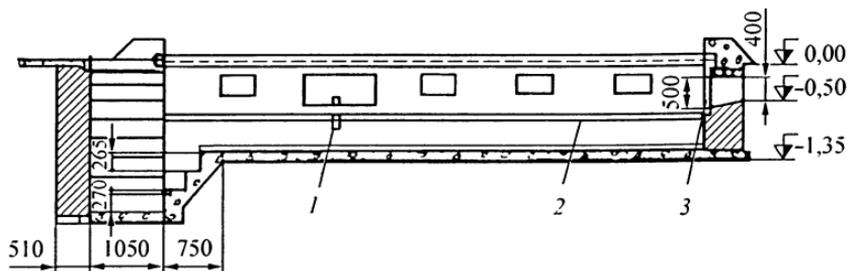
Осмотровая канава в разрезе: 1 — маслопровод; 2 — борозда для электропроводки; 3 — вентиляционный канал
